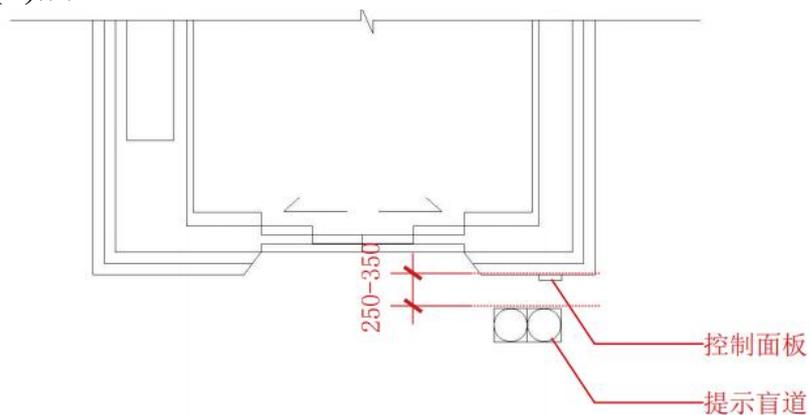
(2) 无障碍电梯提示盲道示意图 (单位: mm)
